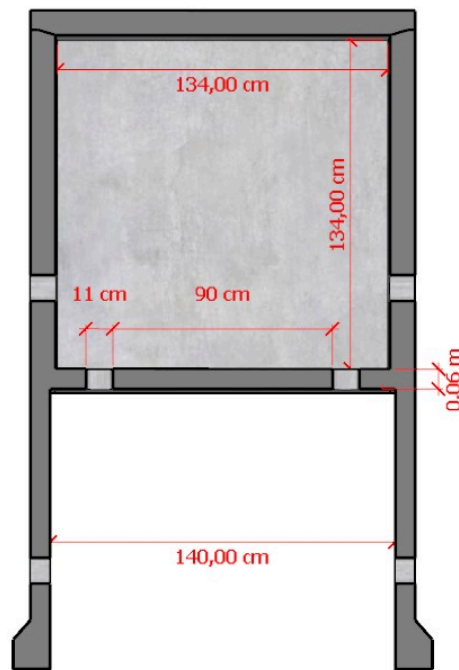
Secção frontal da cabine de medição com as principais dimensões
